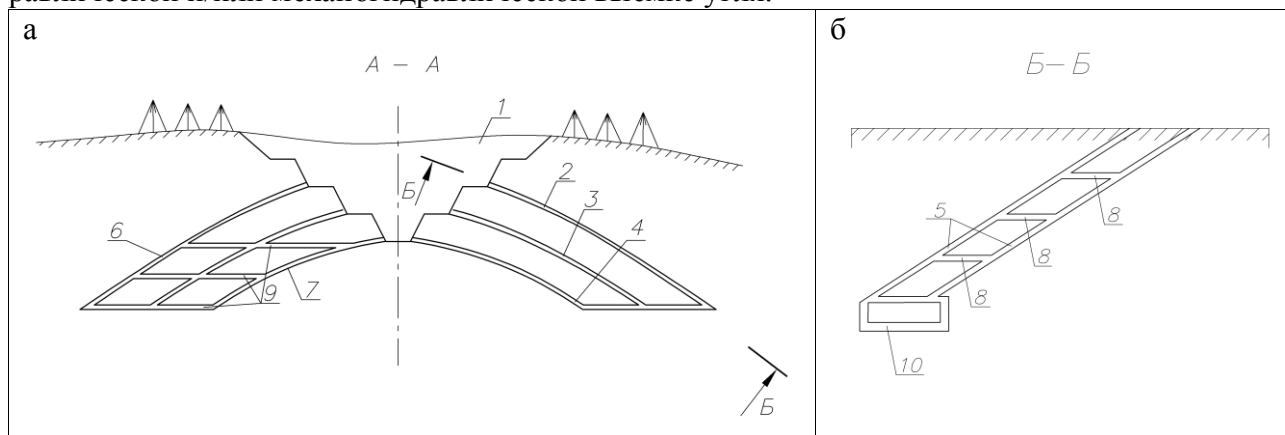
Схема вскрытия пластов месторождения открытым способом: а - разрез А-А; б - разрез Б-Б
